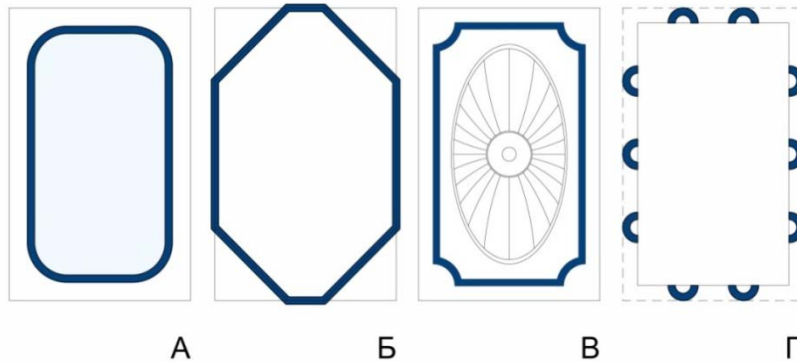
Народные методы борьбы с неблагоприятной энергоинформатикой зданий-кристаллов: А – скругление углов между стенами, между полом и стенами, между стенами и потолком; Б – строительство зданий со срезанными углами; В – создание напольных и потолочных орнаментов по схемам антеннирующих устройств, изменяющих характеристики различных патогенных излучений; Г – создание периметральных колоннад или пилястр с метрикой ордерных систем, подобранных под характеристики геоизлучений по схемам прерывистой периметральной антенны. («Мужские» (правоспиновые, «солнечные») и «женские» (левоспиновые, или «лунные») энергопотоки и адекватные им энергоинформационные потоки преобразовывались с помощью ордерных систем)
